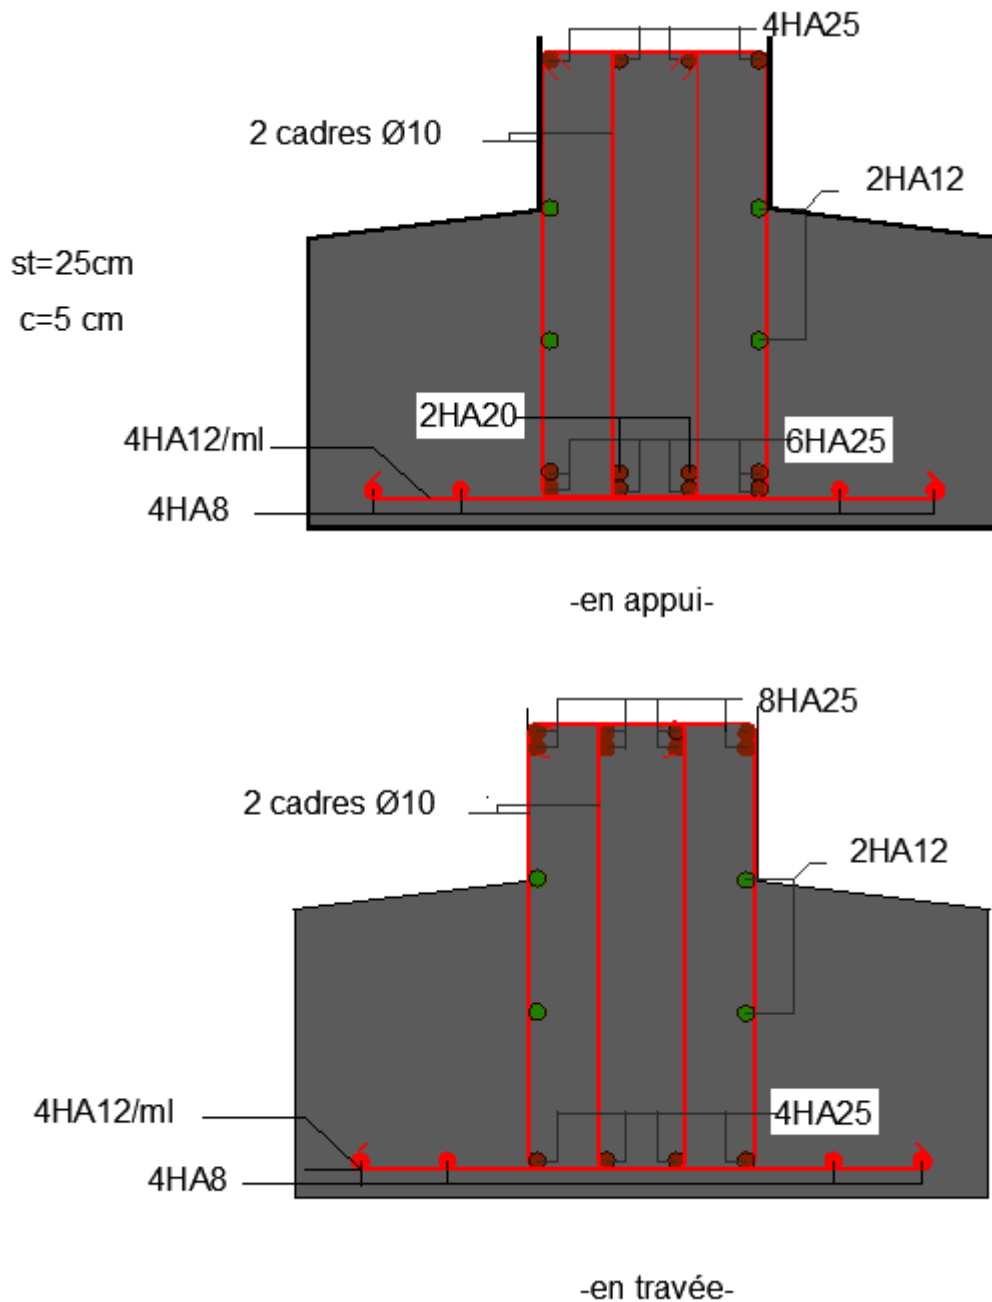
Schémas de ferrailage des semelles filantes et les poutres de rigidités
